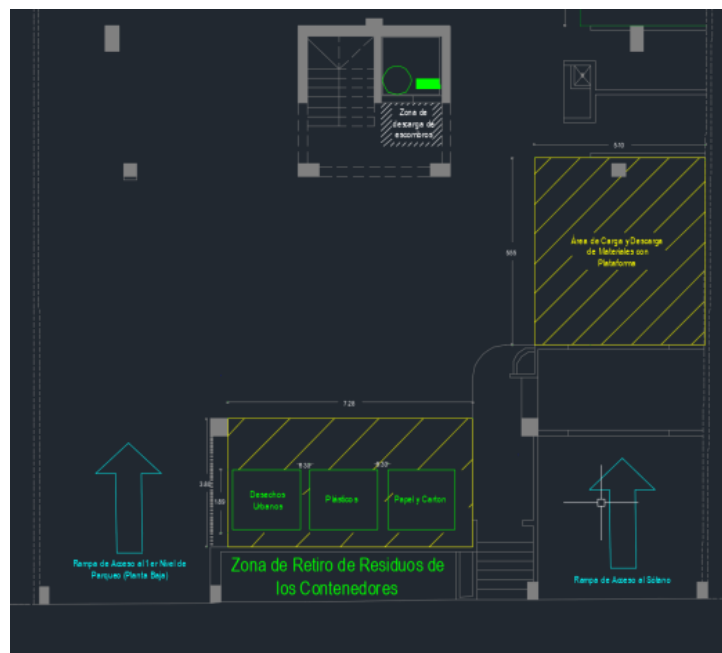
Planos de separación, almacenamiento y manejo de RCD en el 1er Nivel de la obra. Fuente: Elaboración propia
